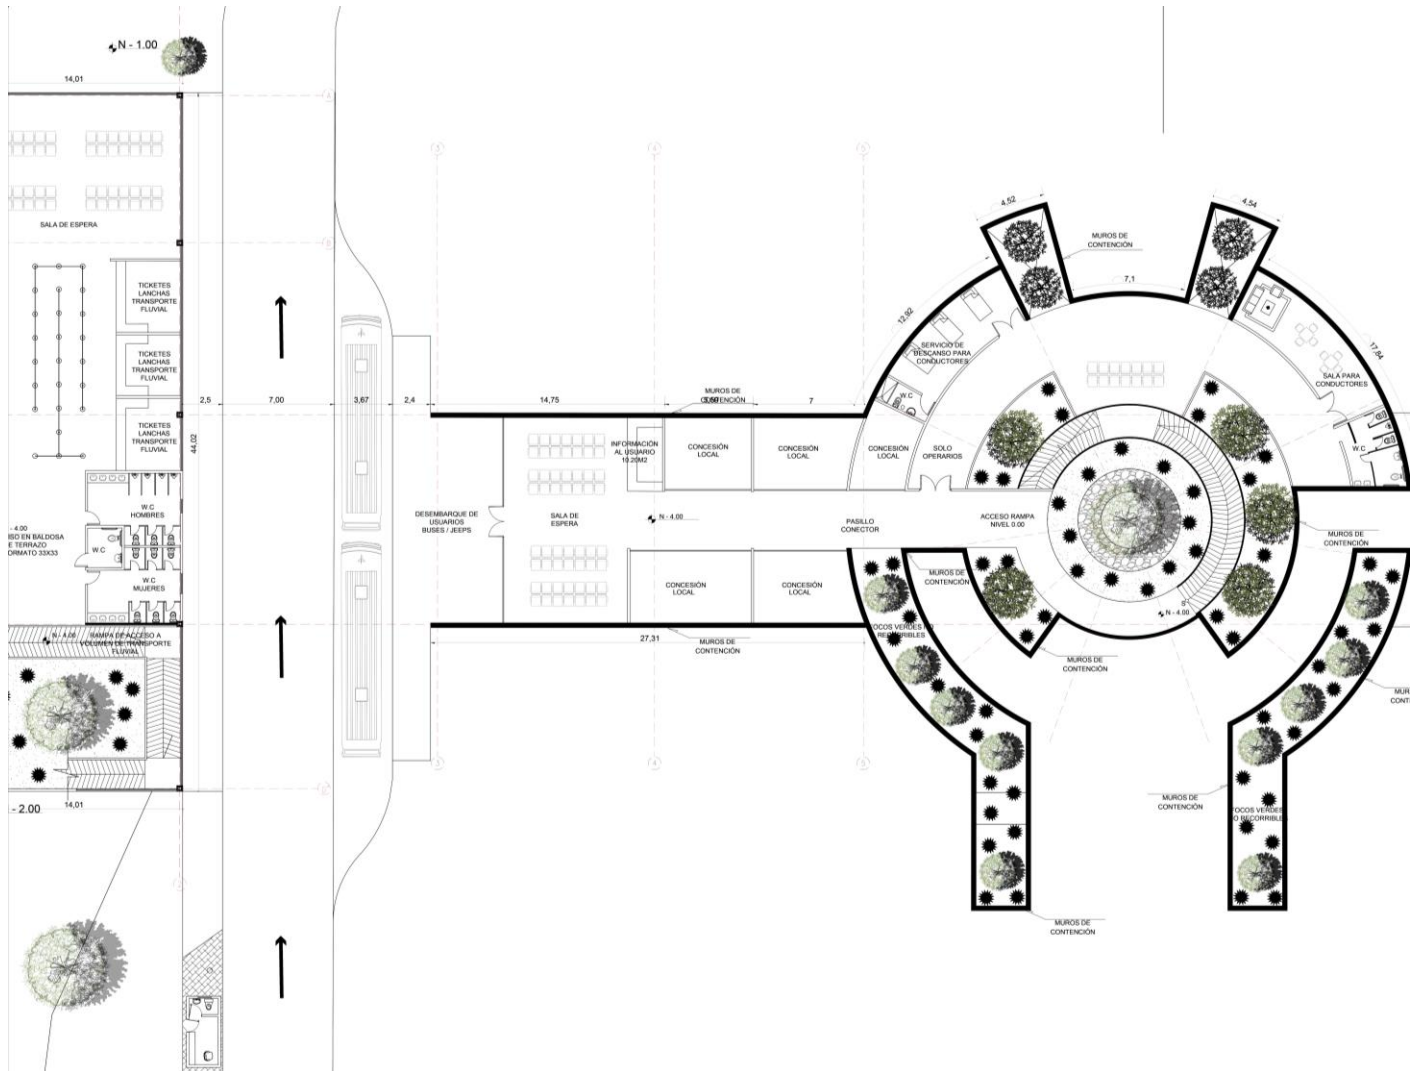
Planimetría amoblada nivel -4.00 parte 1.
